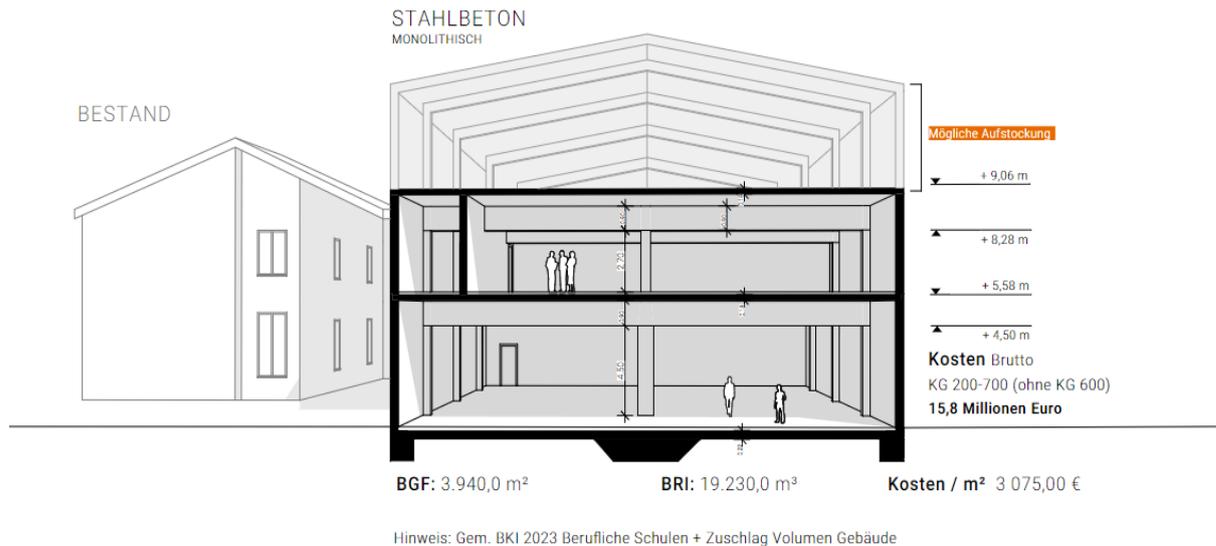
geschossiger Neubau Trakt 9 mit Zufahrtstoren und Gründach
